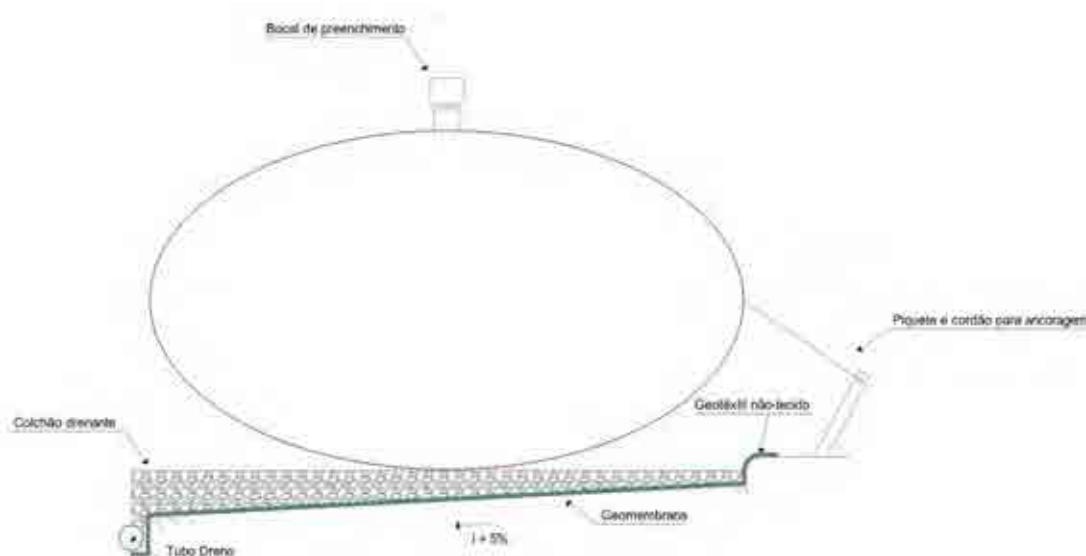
Croqui da instalação (AUTOR, 2011)
